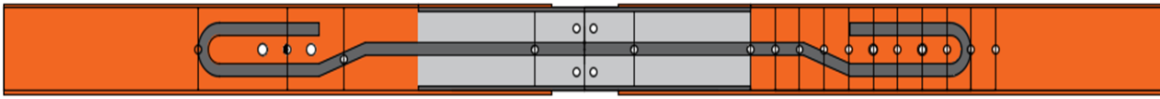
Corte longitudinal del dissipador Tipo 01, se observa el traslape entre el perfil de concreto y los perfiles metálicos
